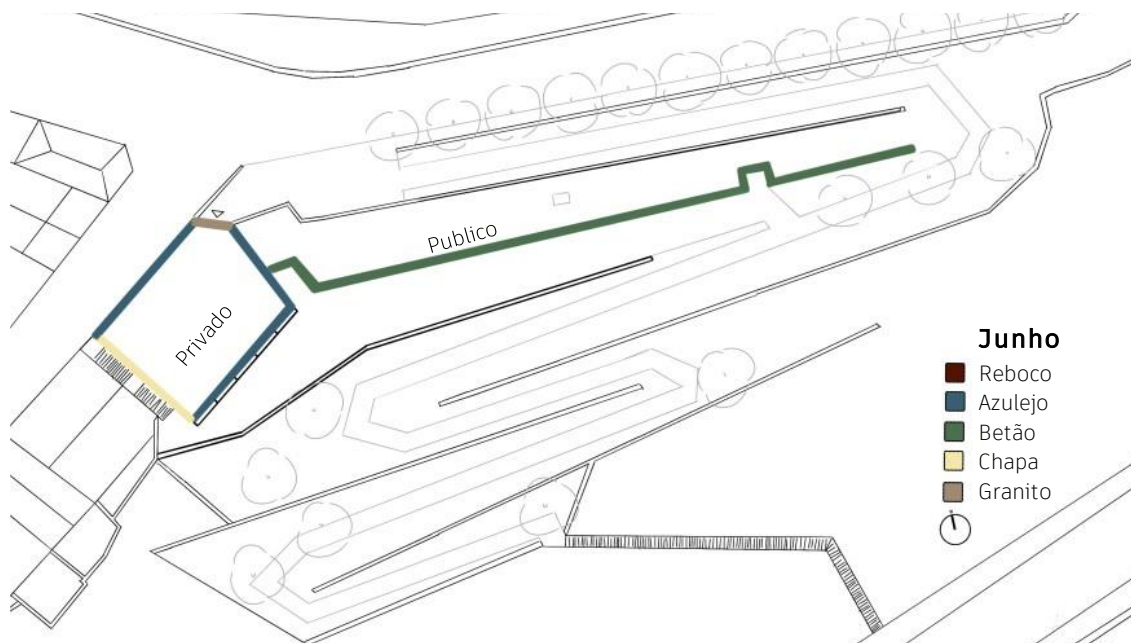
planta esquemática com representação do tipo de revestimento pensado para as diferentes fachadas proposta final junho
